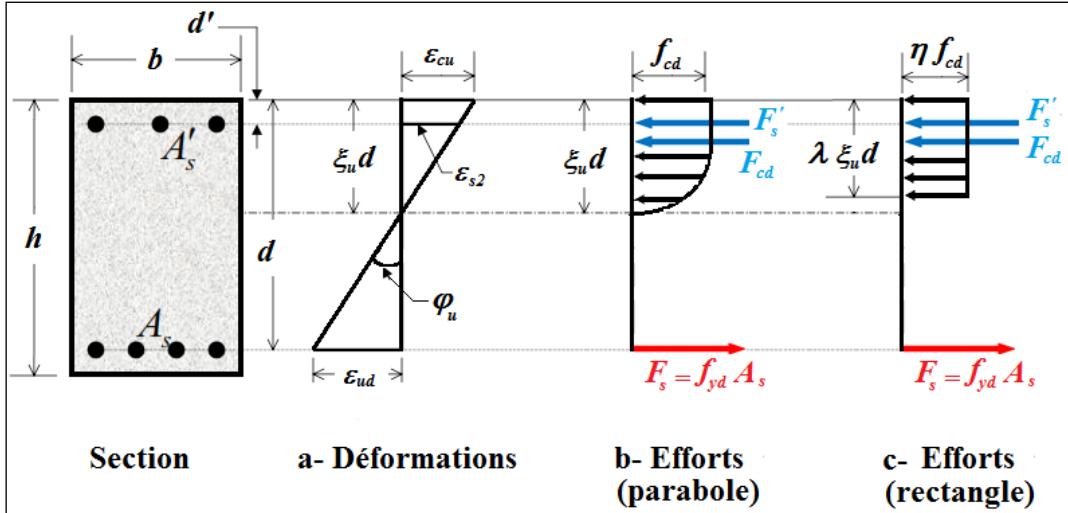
Comportement de la section d'une poutre fléchie en béton armé à l'état limite ultime.
